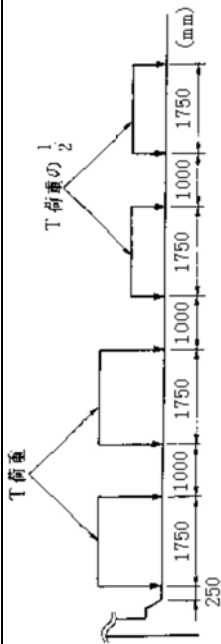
主桁設計時の T 荷重の載荷方法
